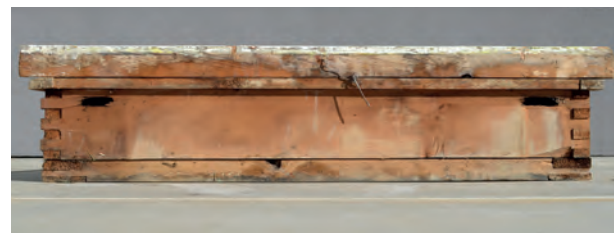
Okenní rám z exteriéru včetně zachovaných závěsů ventilačního okna a obrtlíků.
